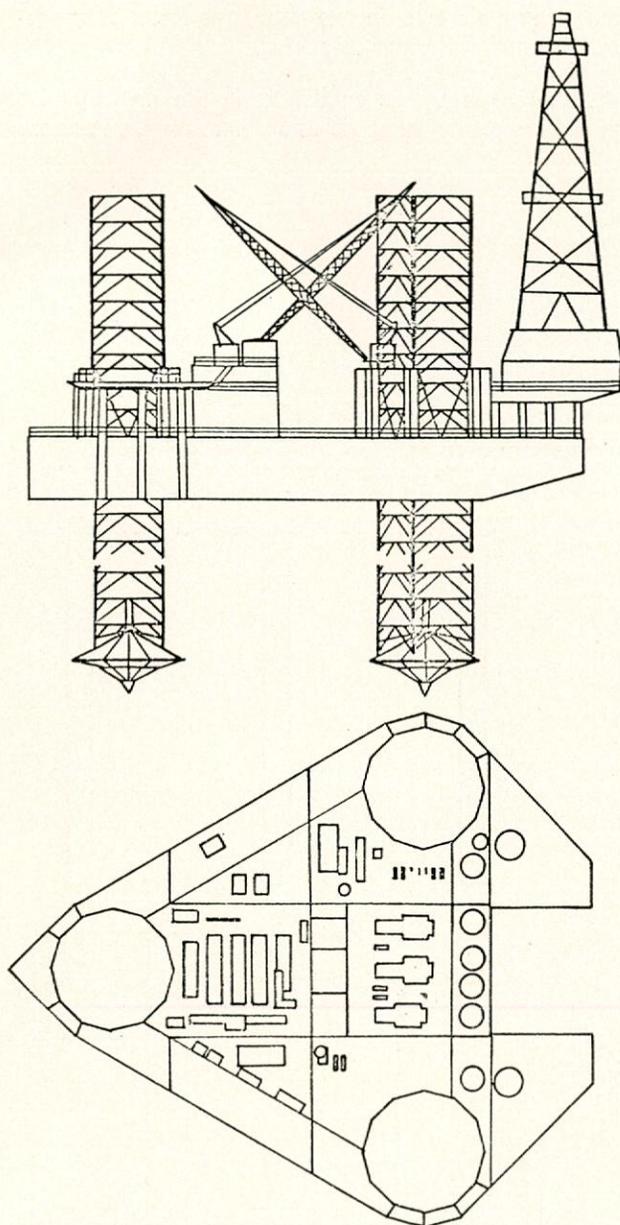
Plataforma levadiza (flour drilling services) con patas de tipo abierto.
